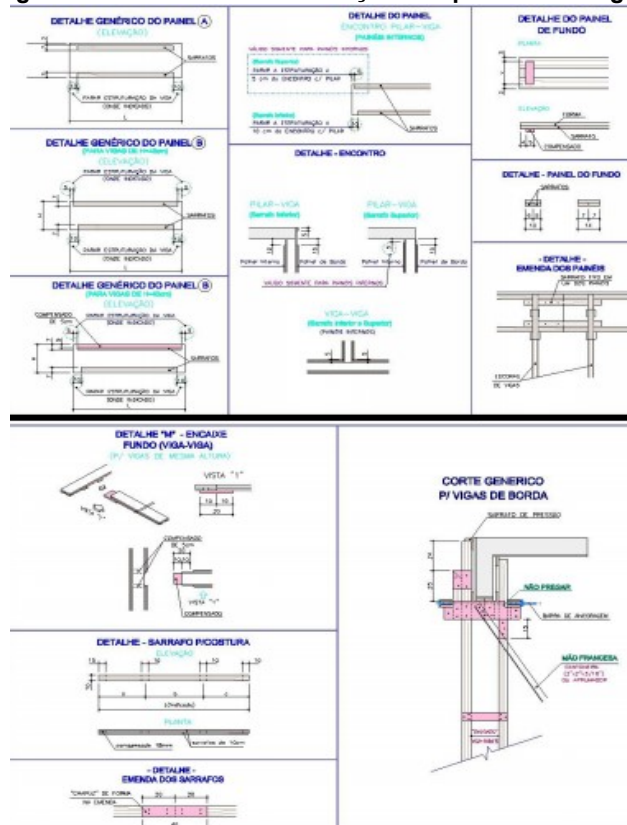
Projeto de distribuição das escoras de viga: travamentos/detalhe das escoras
